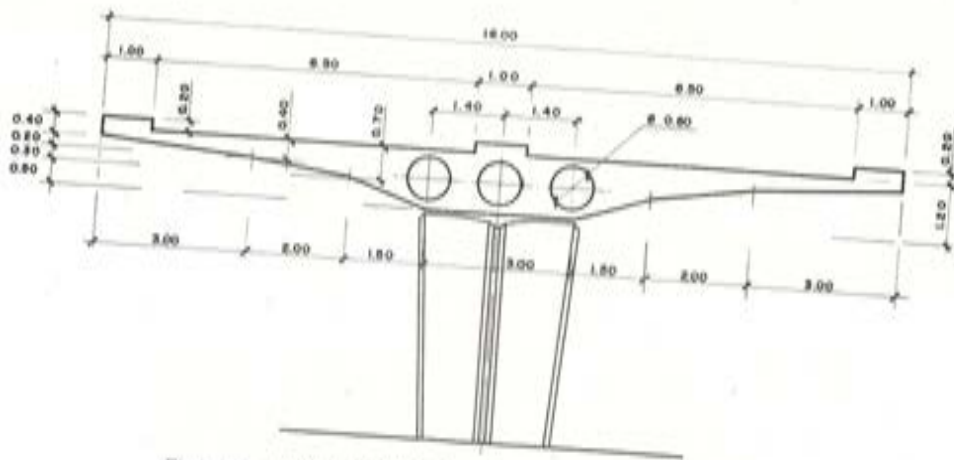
Paso de Cuatro Caminos (sección transversal).
